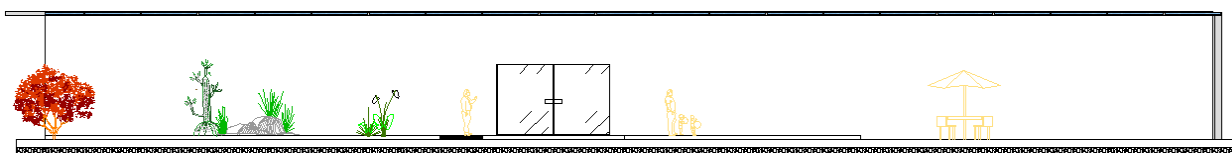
Fachada Lateral Cancha Deportiva
